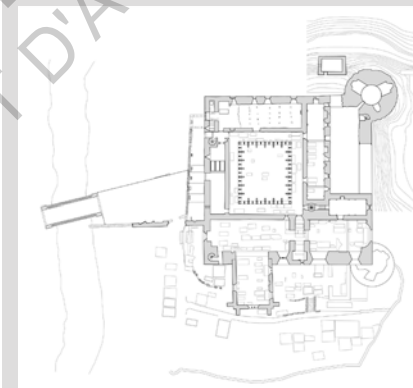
Plan du rez-de-chaussée de l'abbaye
